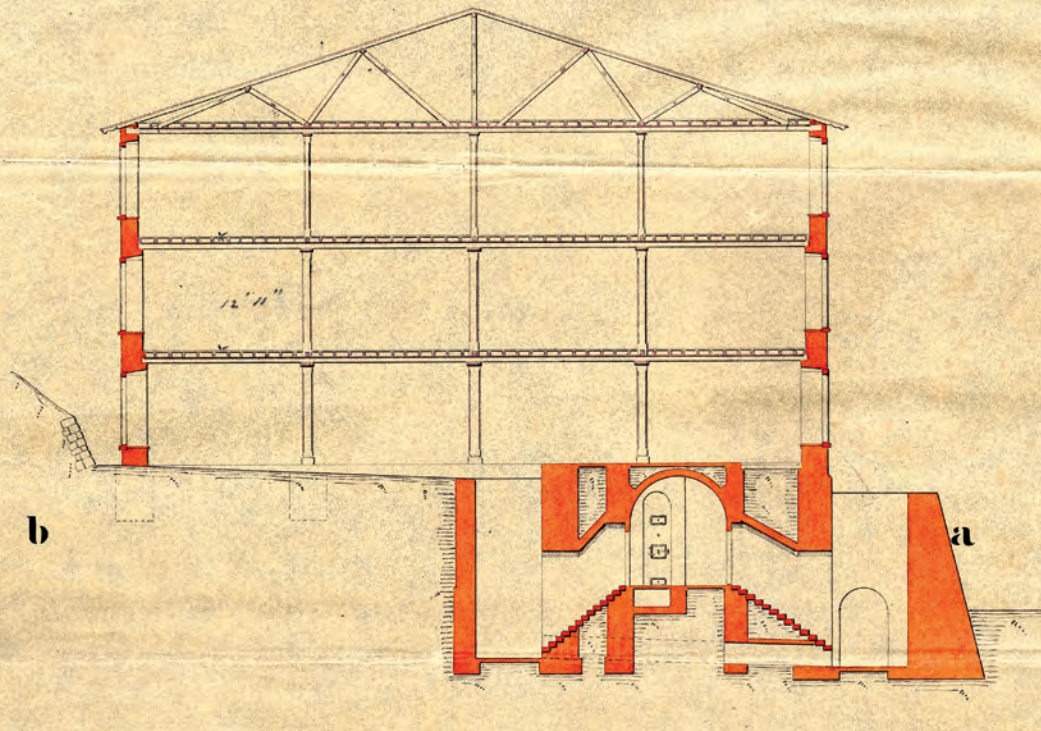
Ausschnitt aus dem Bauplan der Spinnerei Rüf 1865
